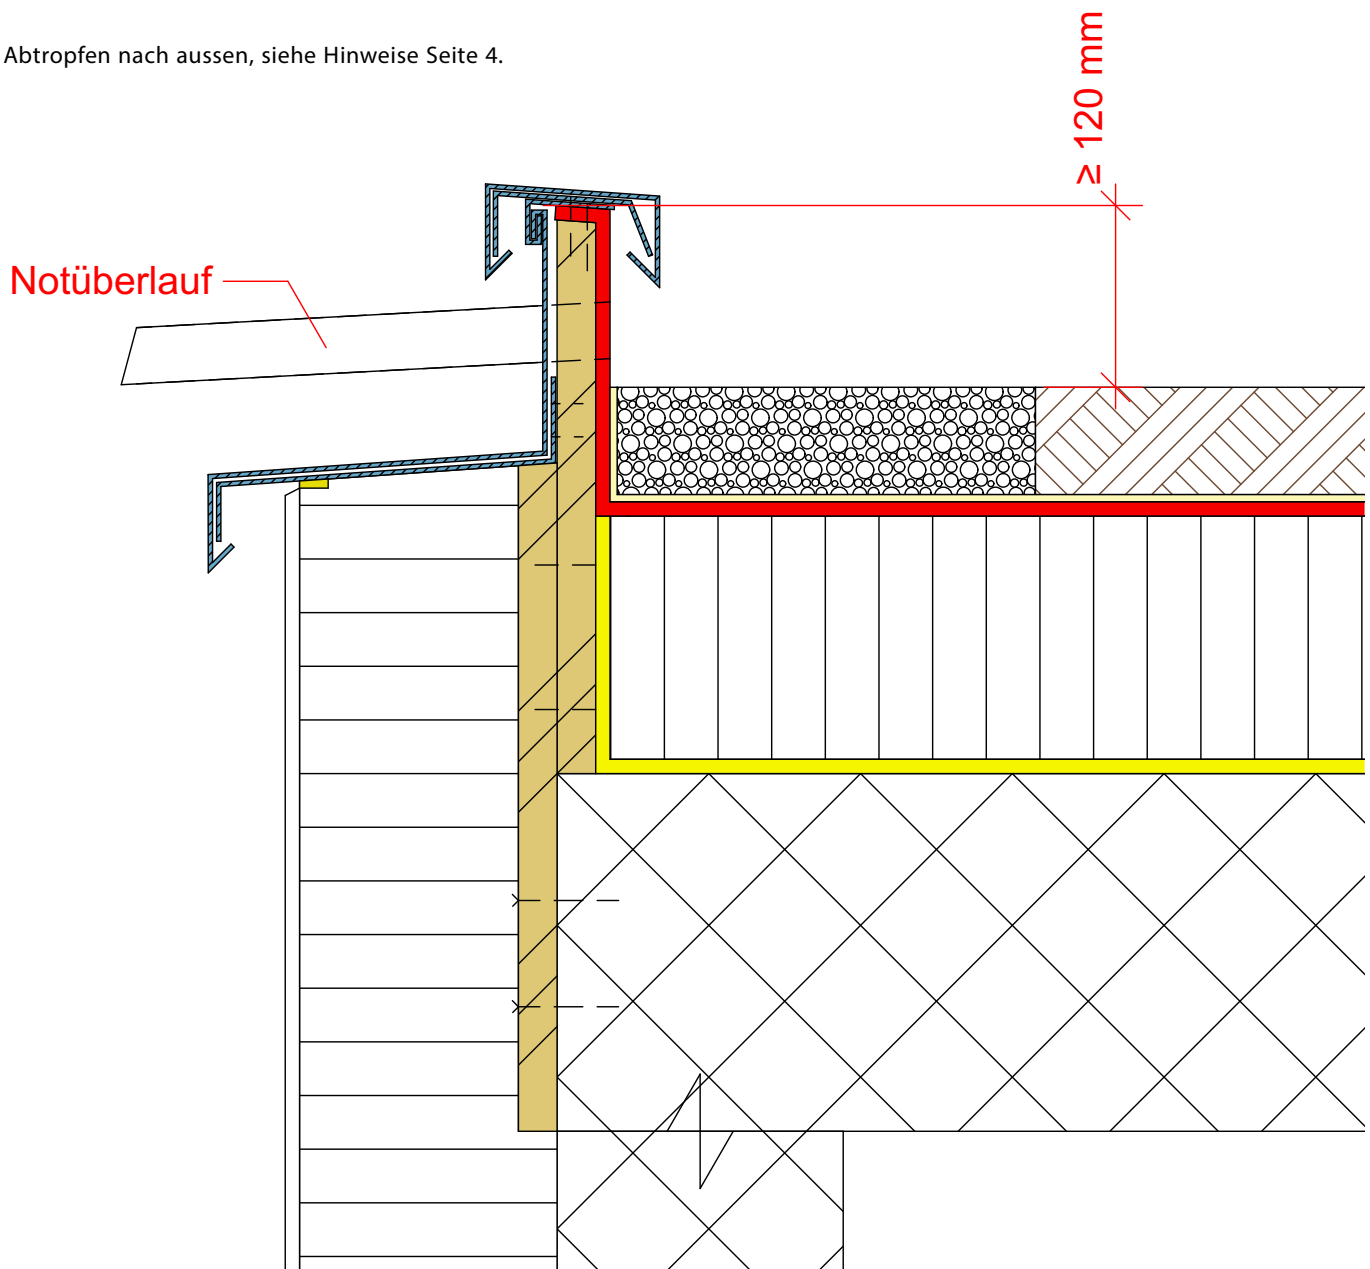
Nicht überlaufsichere Dachrandkonstruktionen
